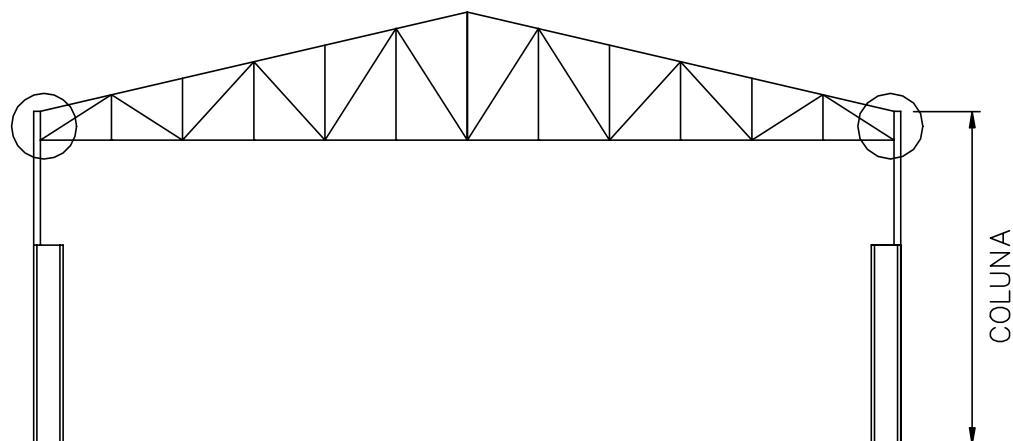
Ligação rígida entre tesoura e coluna.
